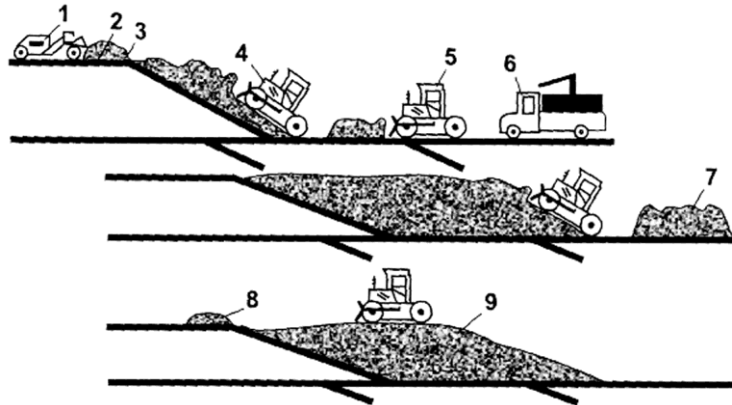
Укладка отходов методом «надвига» (снизу вверх):
